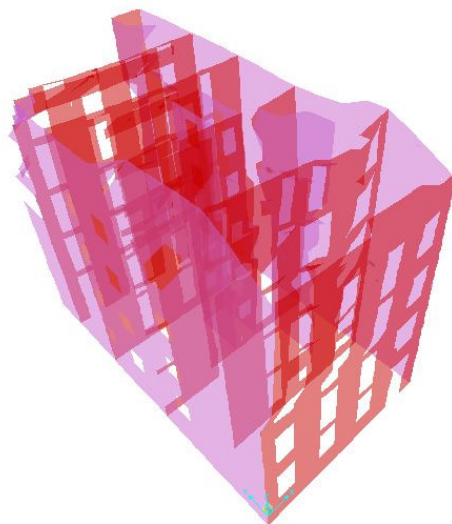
Configuração deformada da estrutura para acção sísmica do tipo 1 considerando ligações fracas entre as paredes de empena e fachadas
